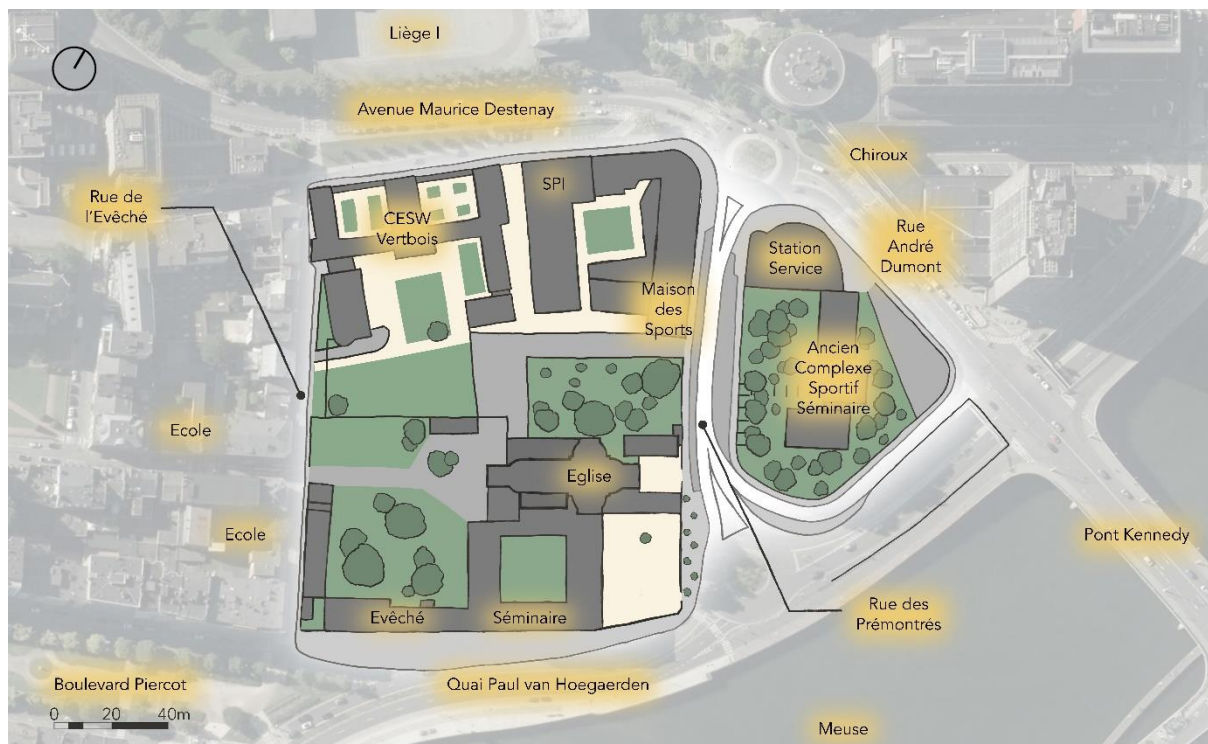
Plan de situation (fond de plan WalOnMap, 2016)
